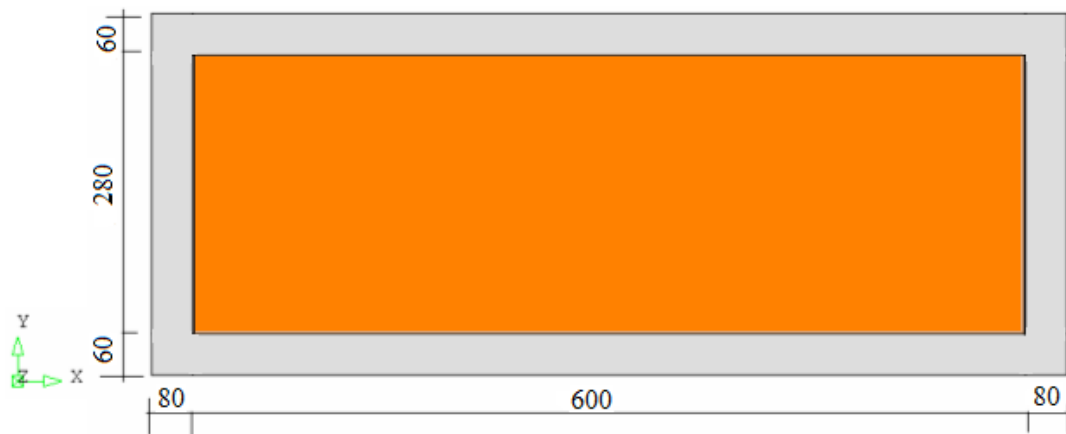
Dimensões dos elementos estruturais e da parede de alvenaria de vedação com 14 cm de espessura – modelo pórtico / alvenaria, utilizado no estudo paramétrico (dimensões em centímetros).
